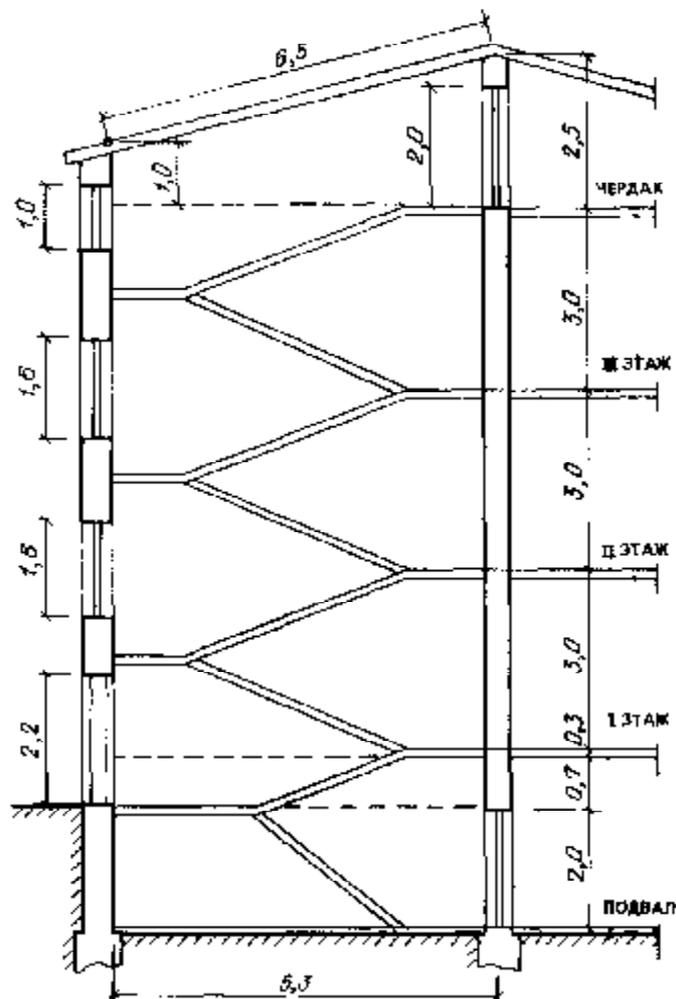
Разрез жилого здания по лестничной клетке (к примеру 8.2)
